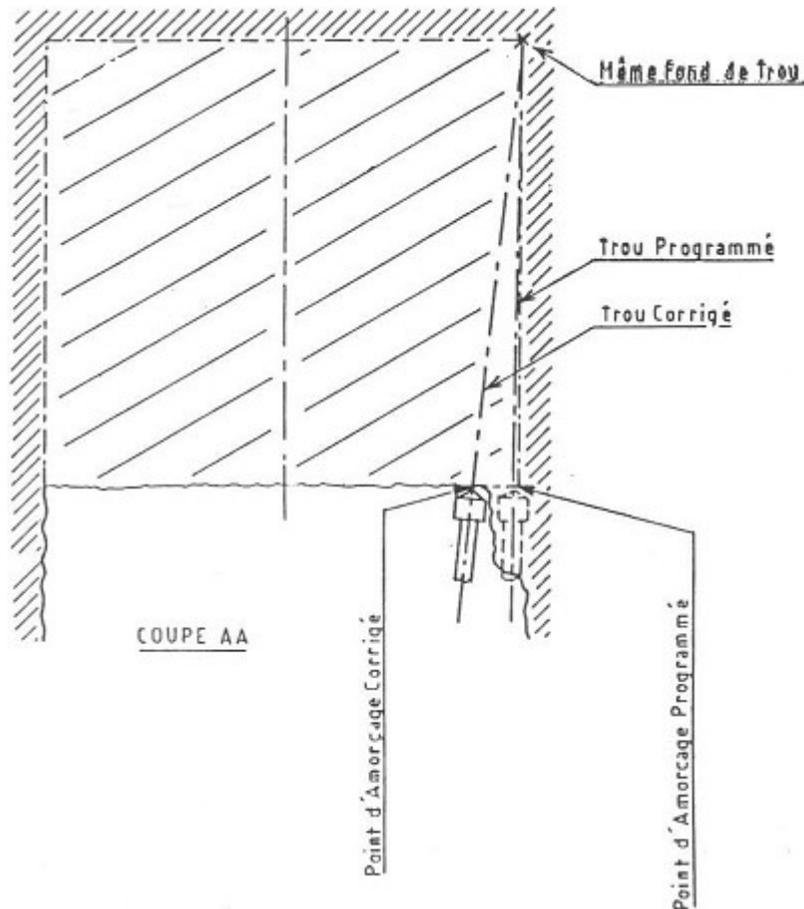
Tunnel de la Duchère - Site Propre BUS - Plan de Tir Pleine Section
